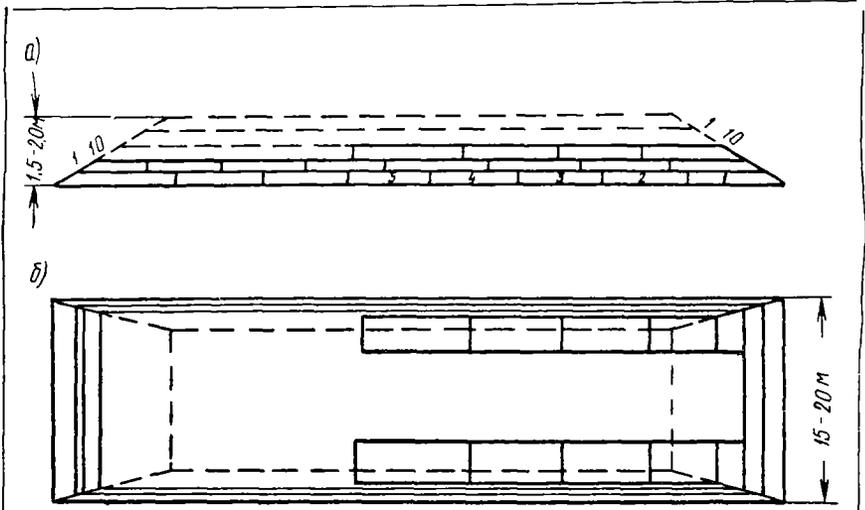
Схема укладки растительного грунта в призмы скрепером:
